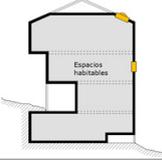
Cerramiento fachada sur. 2022. Fuente propia
